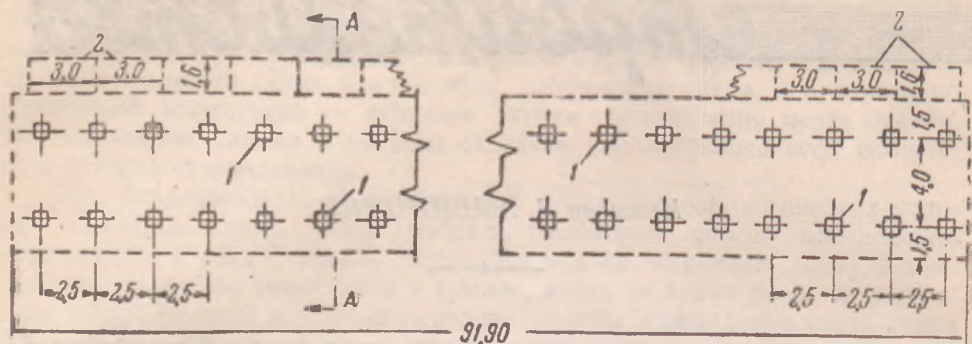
План свайного основания причала: 1) жел.-бет. сваи; 2) бетонные массивы
